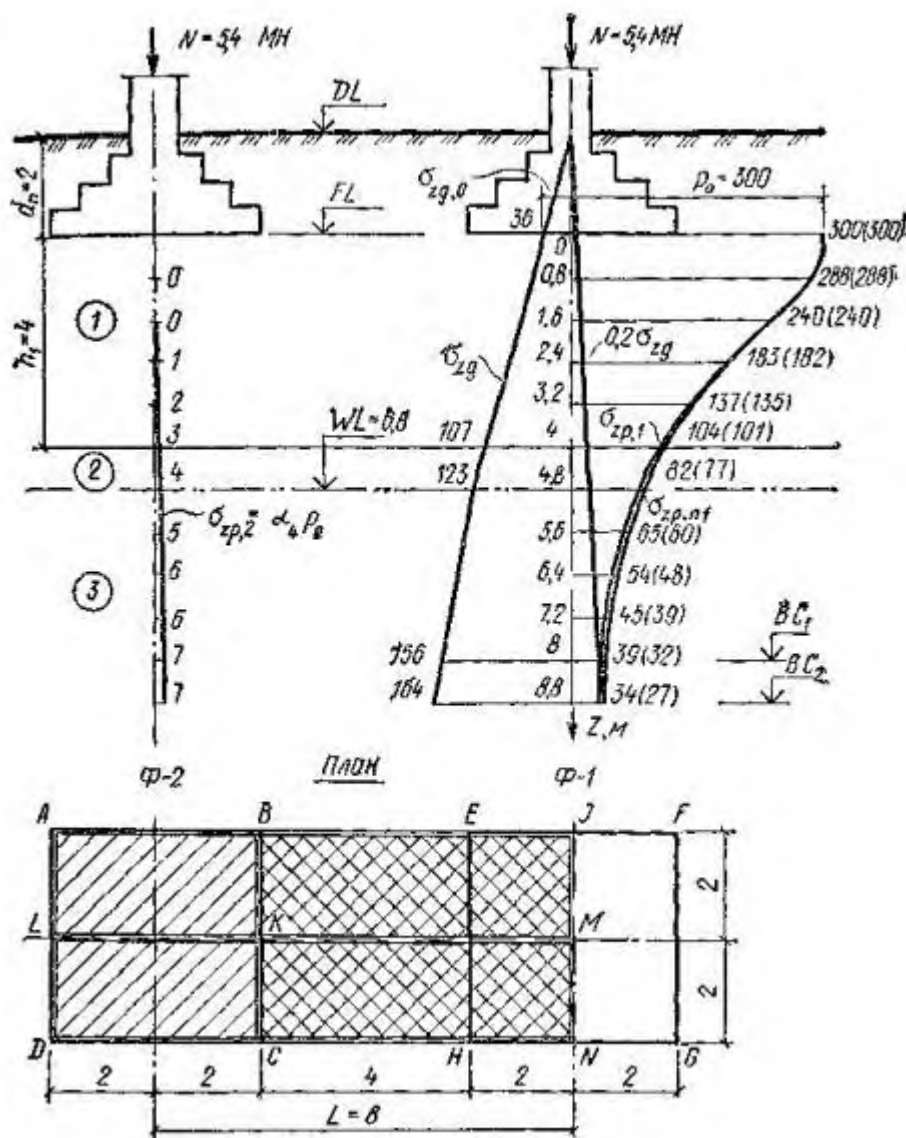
К расчету осадки фундамента Ф-1 с учетом влияния соседнего фундамента Ф-2
